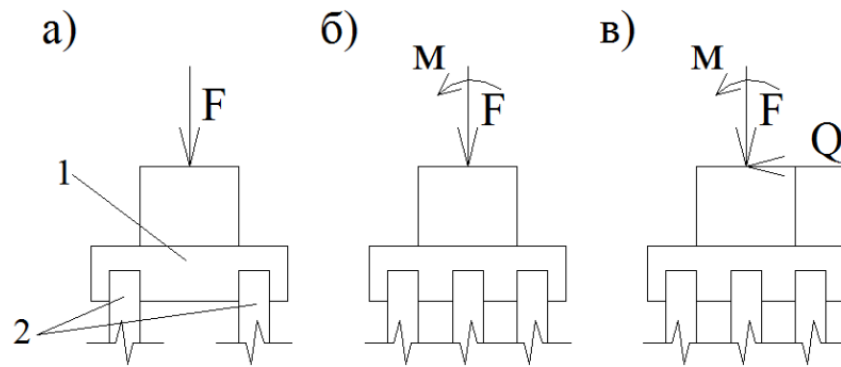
Схемы передаваемых на системы «НРСн – фундамент» нагрузок: 1- фундамент; 2- НРСн.
